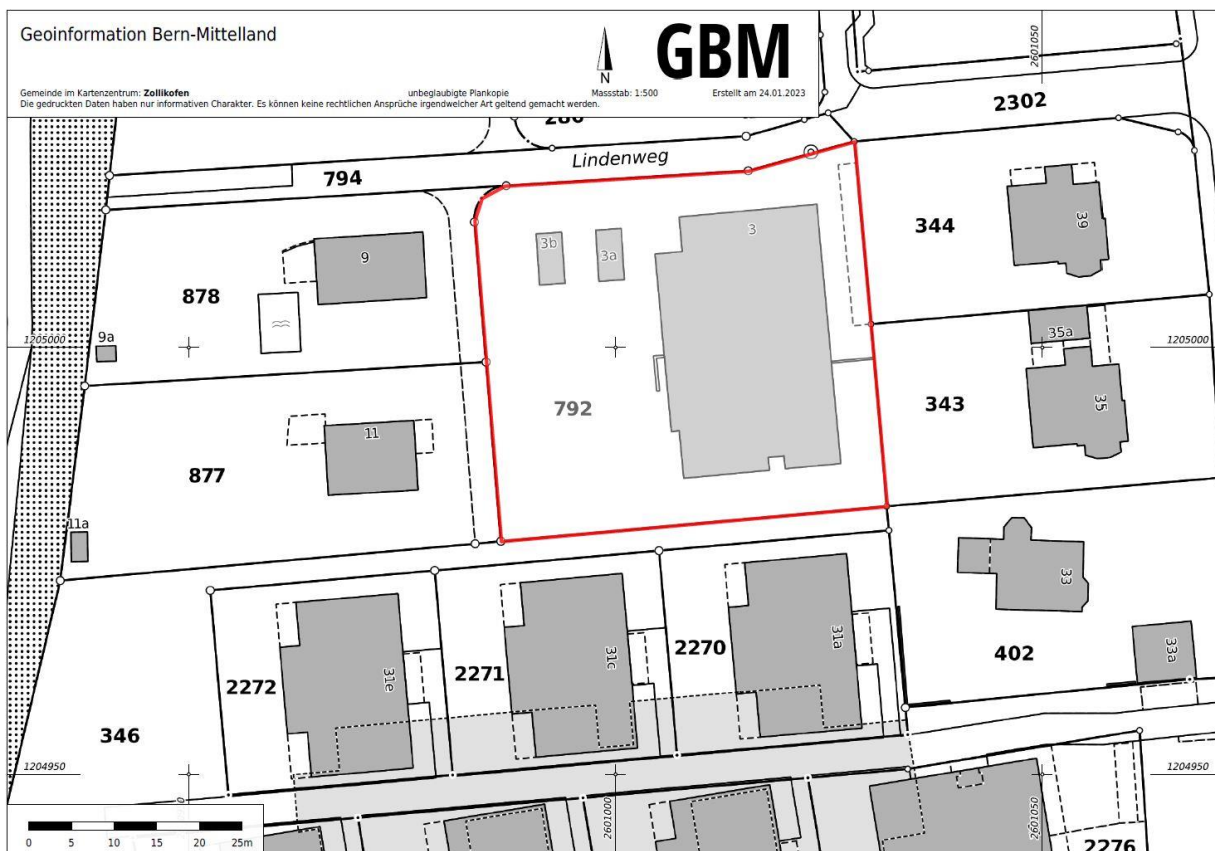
Lageplan Kirchgemeindehaus Zollikofen. Quelle: swissboundaries3D, @swisstopo
